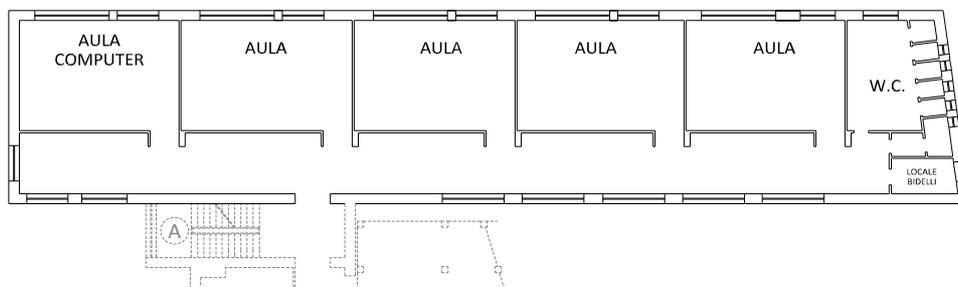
6: Pianta piano seminterrato (blocco aule 2).
